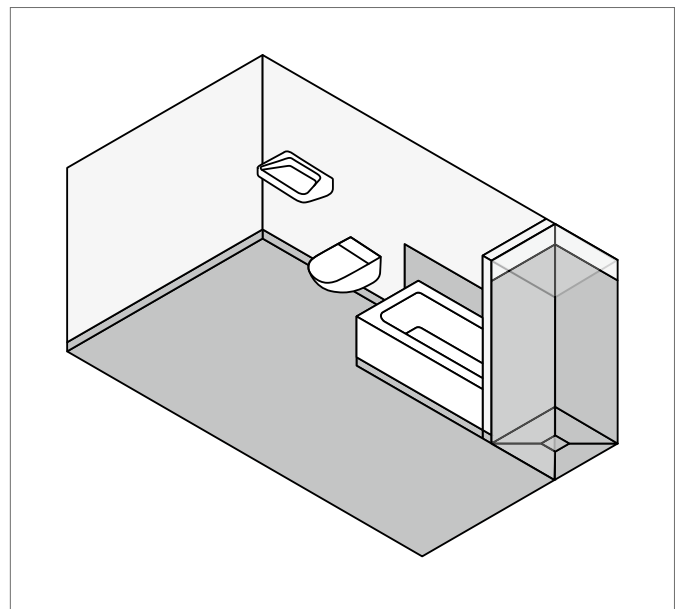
Bathtub without shower, shower walls, shower tray with floor drain and room floors sealed against water ingress
